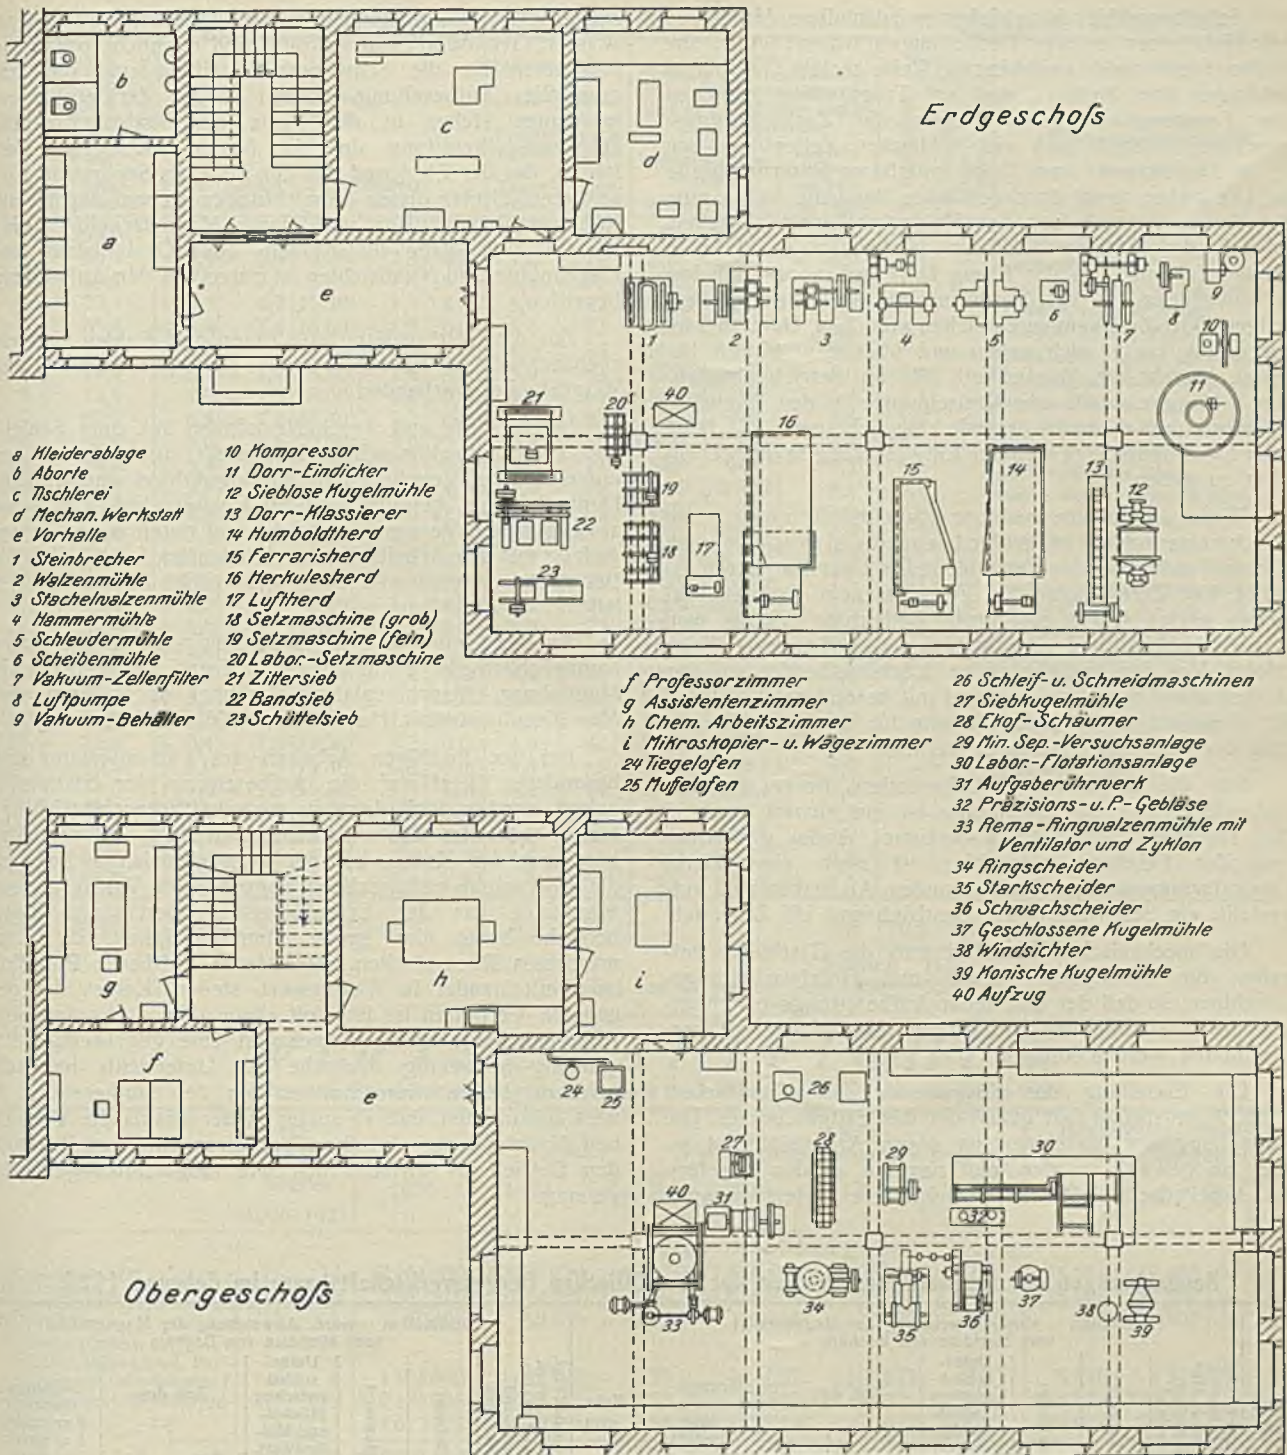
Grundrisse der beiden Stockwerke des Aufbereitungslaboratoriums.
